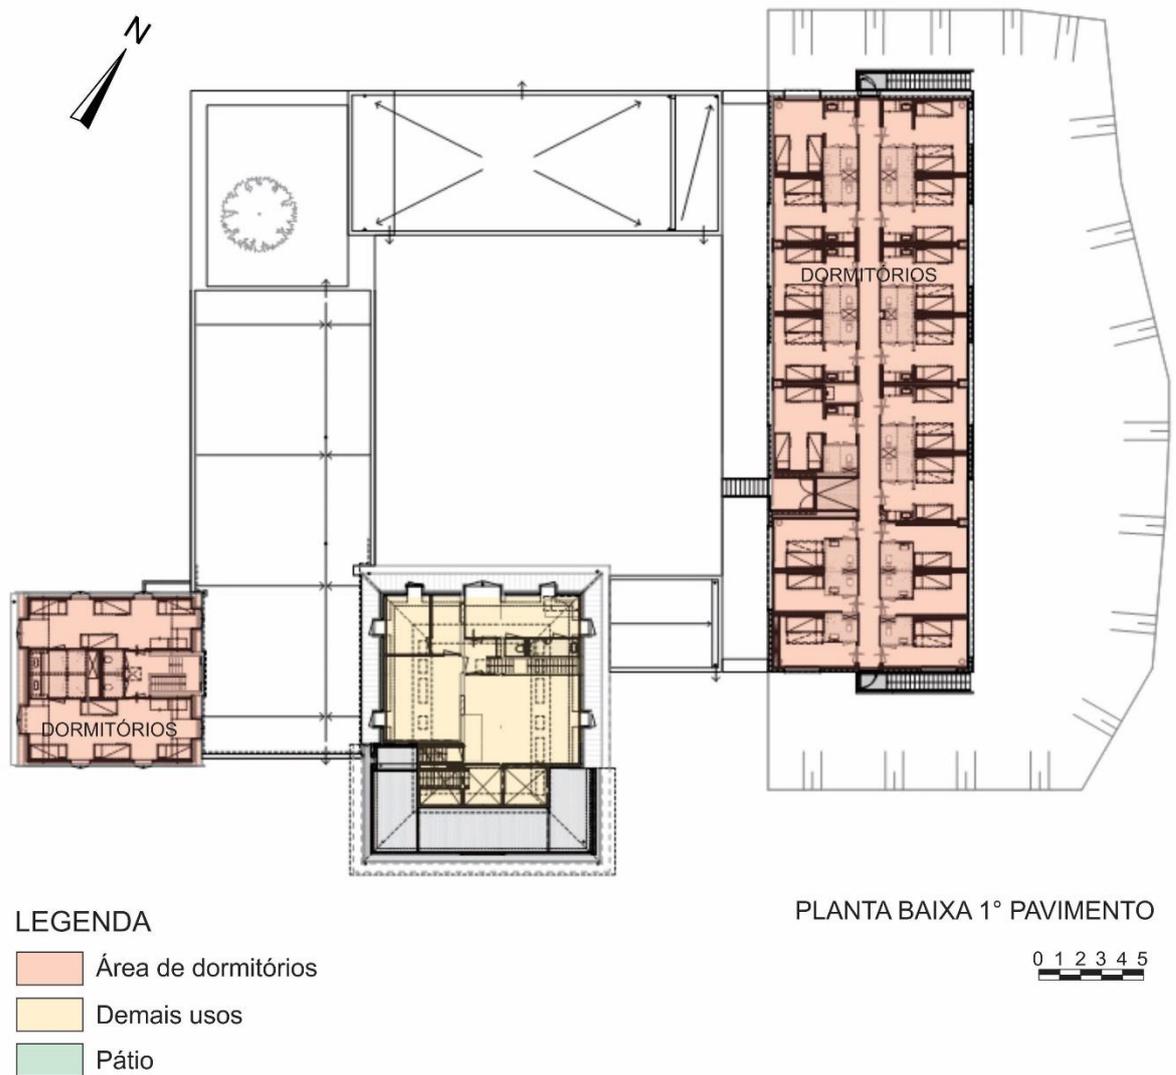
Planta baixa do primeiro pavimento do Stayokay Hostel Soest. FONTE: ARCHDAILY (2012, adaptada pela autora).
